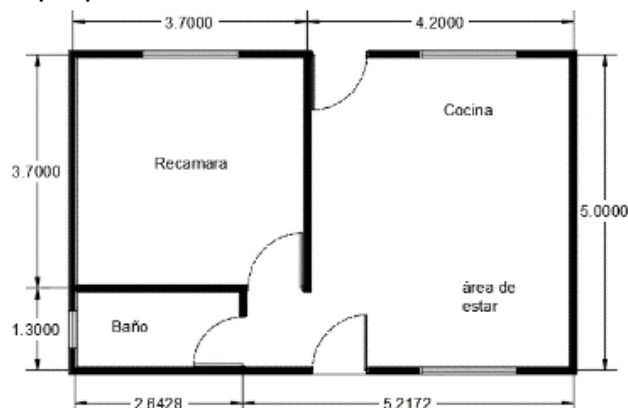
Planta arquitectónica de proyecto inicial, elaboración propia.
